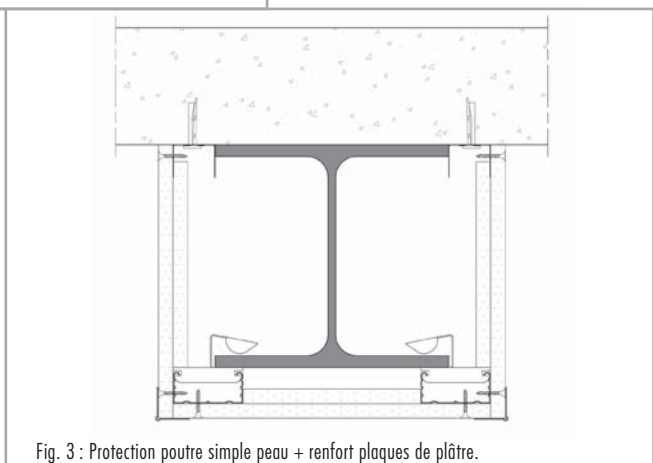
Protection poutre simple peau + renfort plaques de plâtre.
